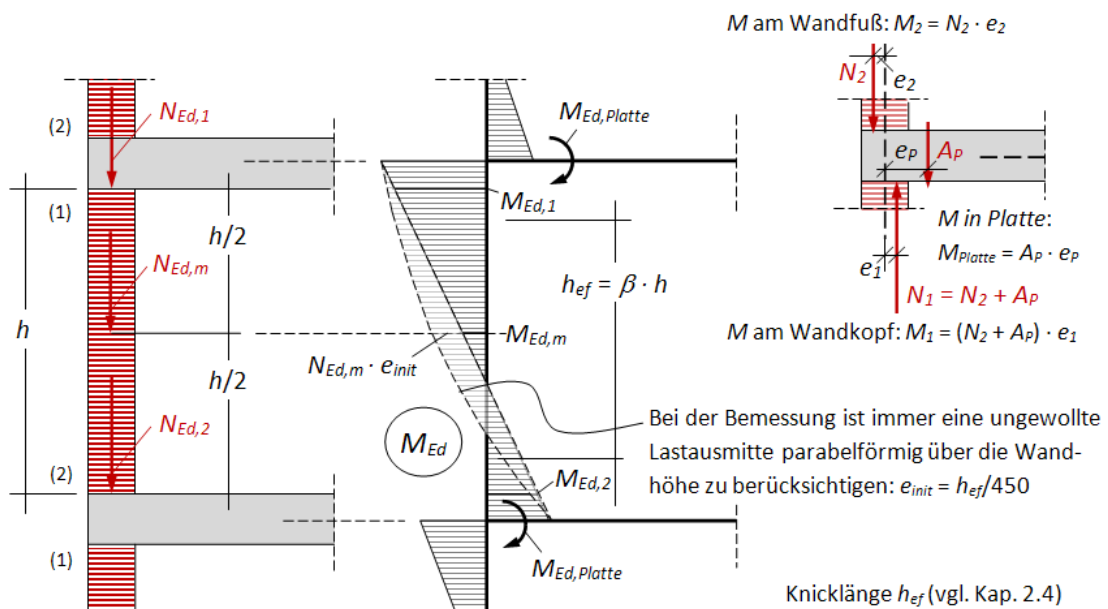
Schnittgrößenermittlung – Knotenmomente - Bezeichnungen
